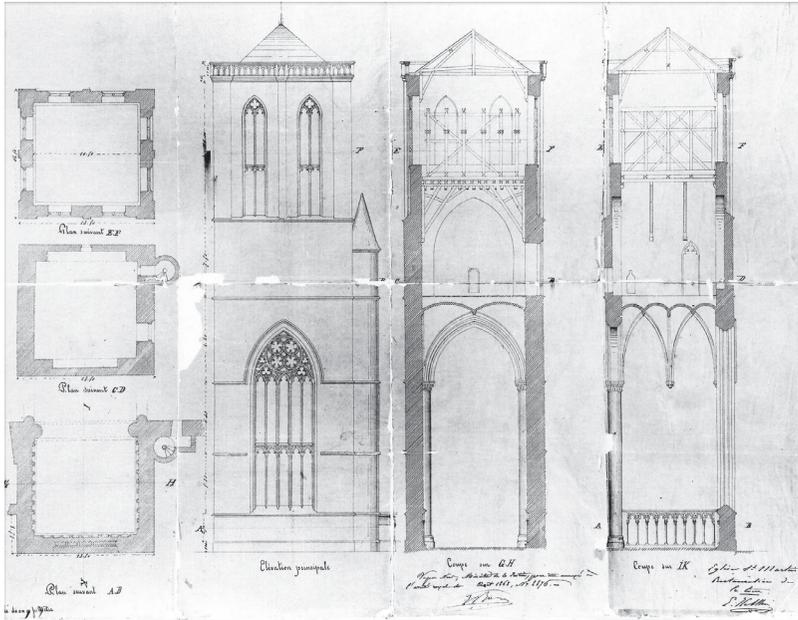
Projet de restauration de la tour (plan, coupe, élévation).
